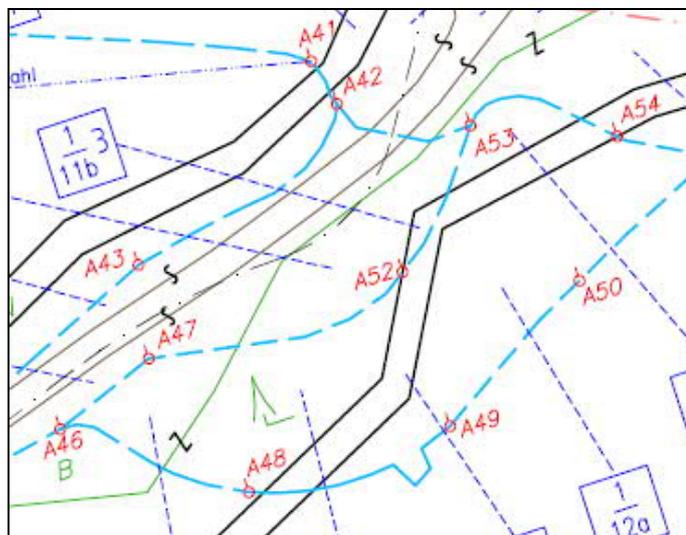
Ausschnitt eines Absteckplanes von Grundeinlösepunkten
